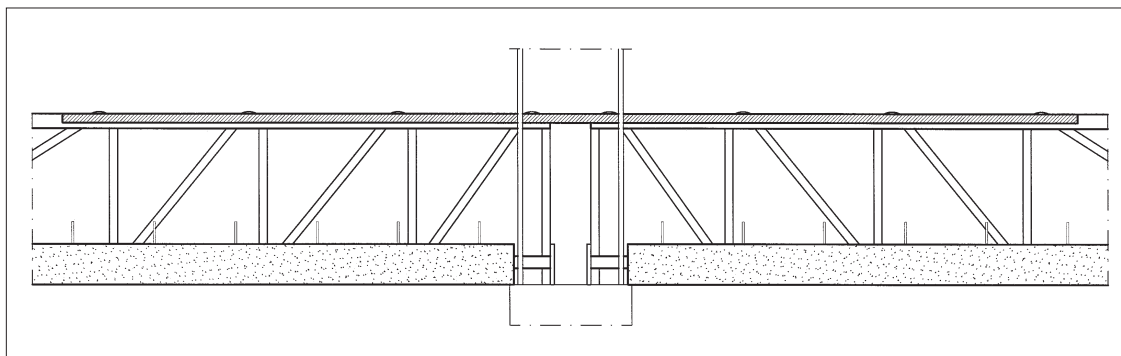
Apparecchio d'appoggio con fondello in cls e traverso piatto.
